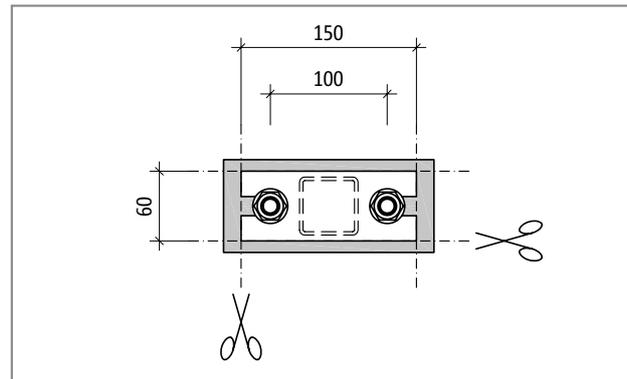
Schöck Isokorb® T type S-V: Dimensions after trimming the insulation body
